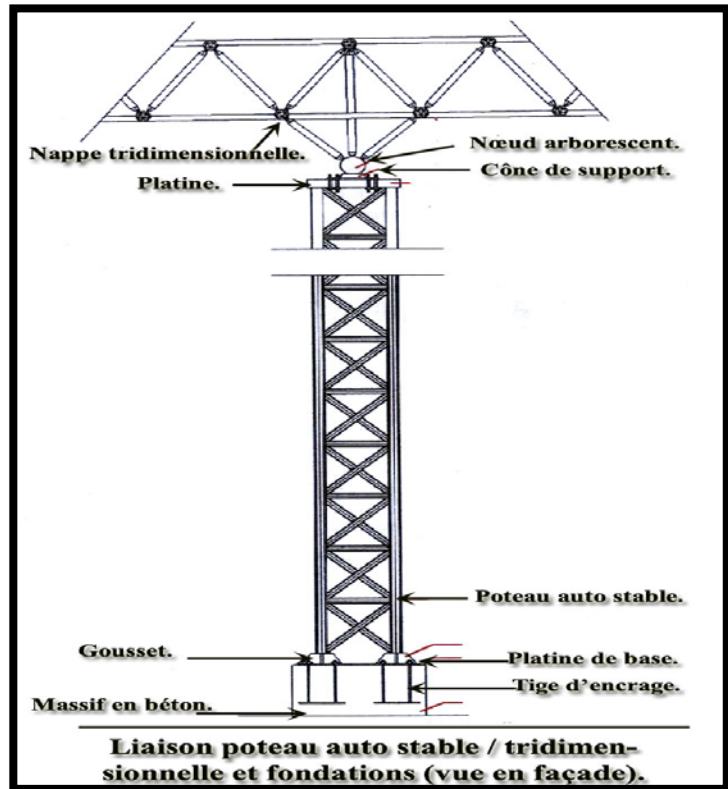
liaison poteau auto stable /tridimensionnelle et fondation
